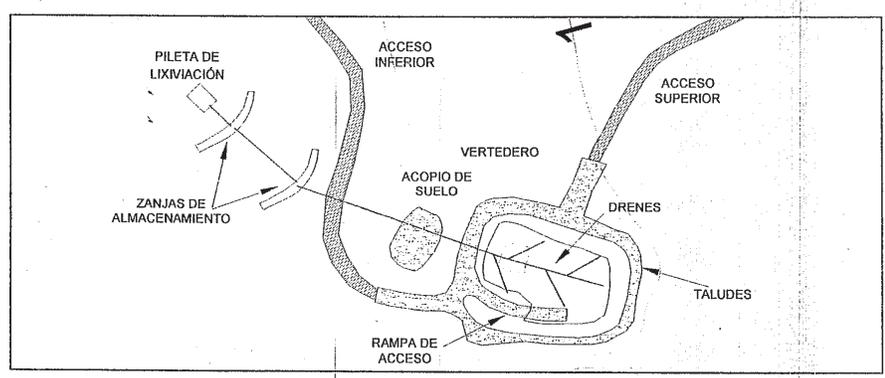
Plano de la distribución del vertedero y las zanjas y pileta de lixiviación
